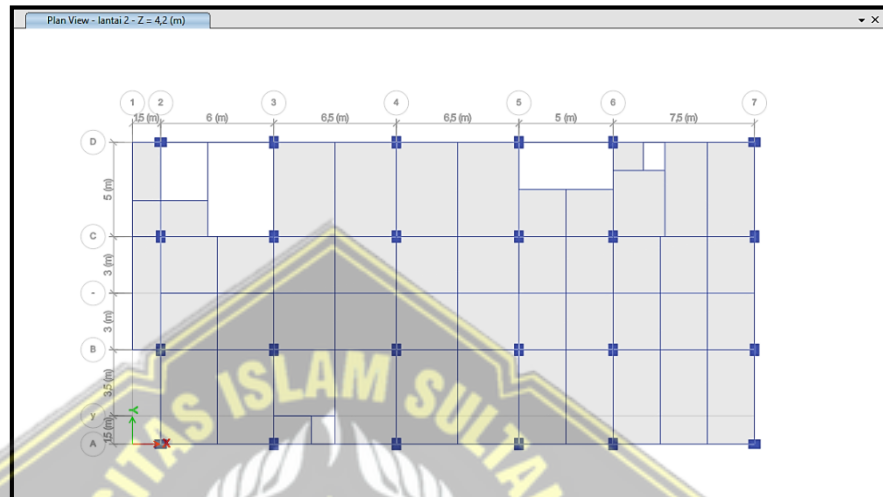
25 Penggambaran Balok Anak Denah Lantai 2
